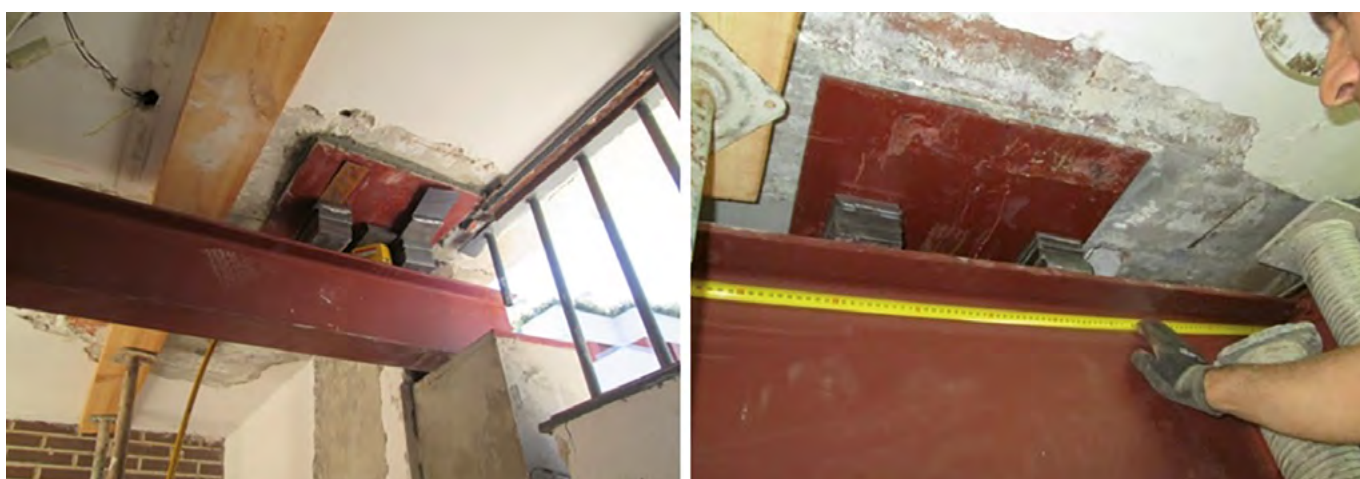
Refuerzo del forjado en los puntos en los que apoya, sobre el forjado existente, la nueva losa de hormigón armado.
